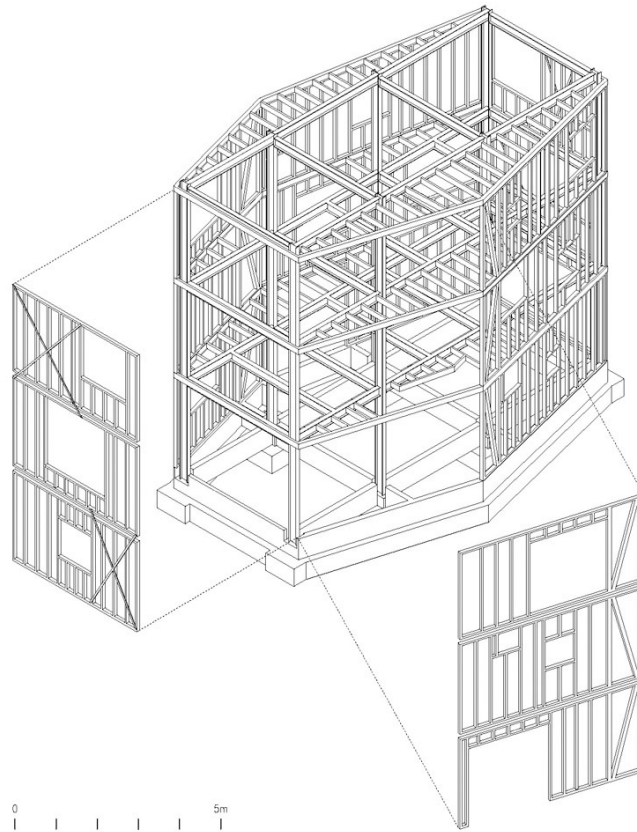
esquema de estrutura mista de estruturas metálicas com LSF
